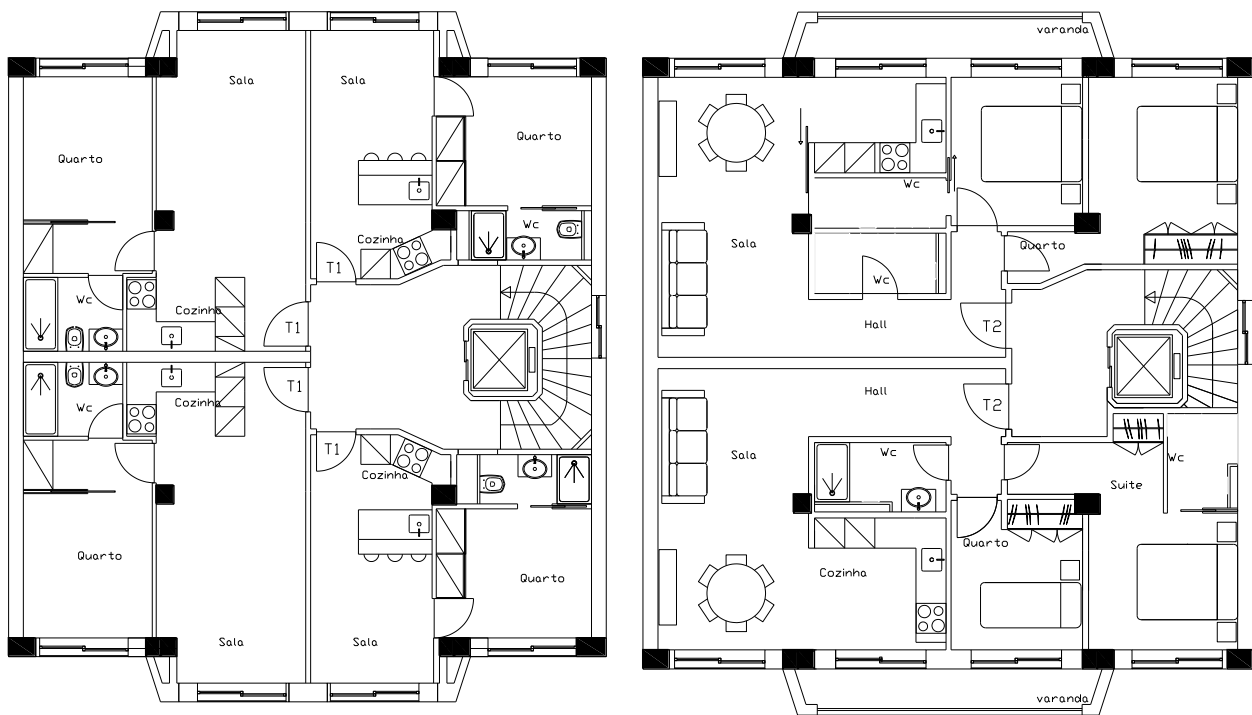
Planta piso 1 ao 5 (à esquerda) e planta piso 6 (à direita)
